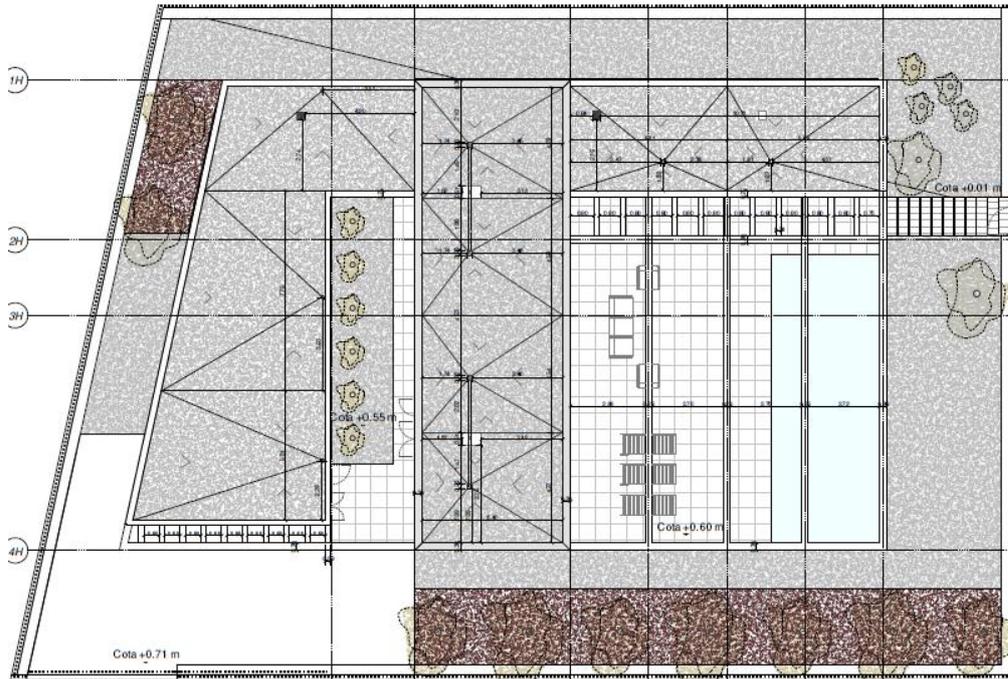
Plano de planta cubierta. 2019. Planos del Proyecto
